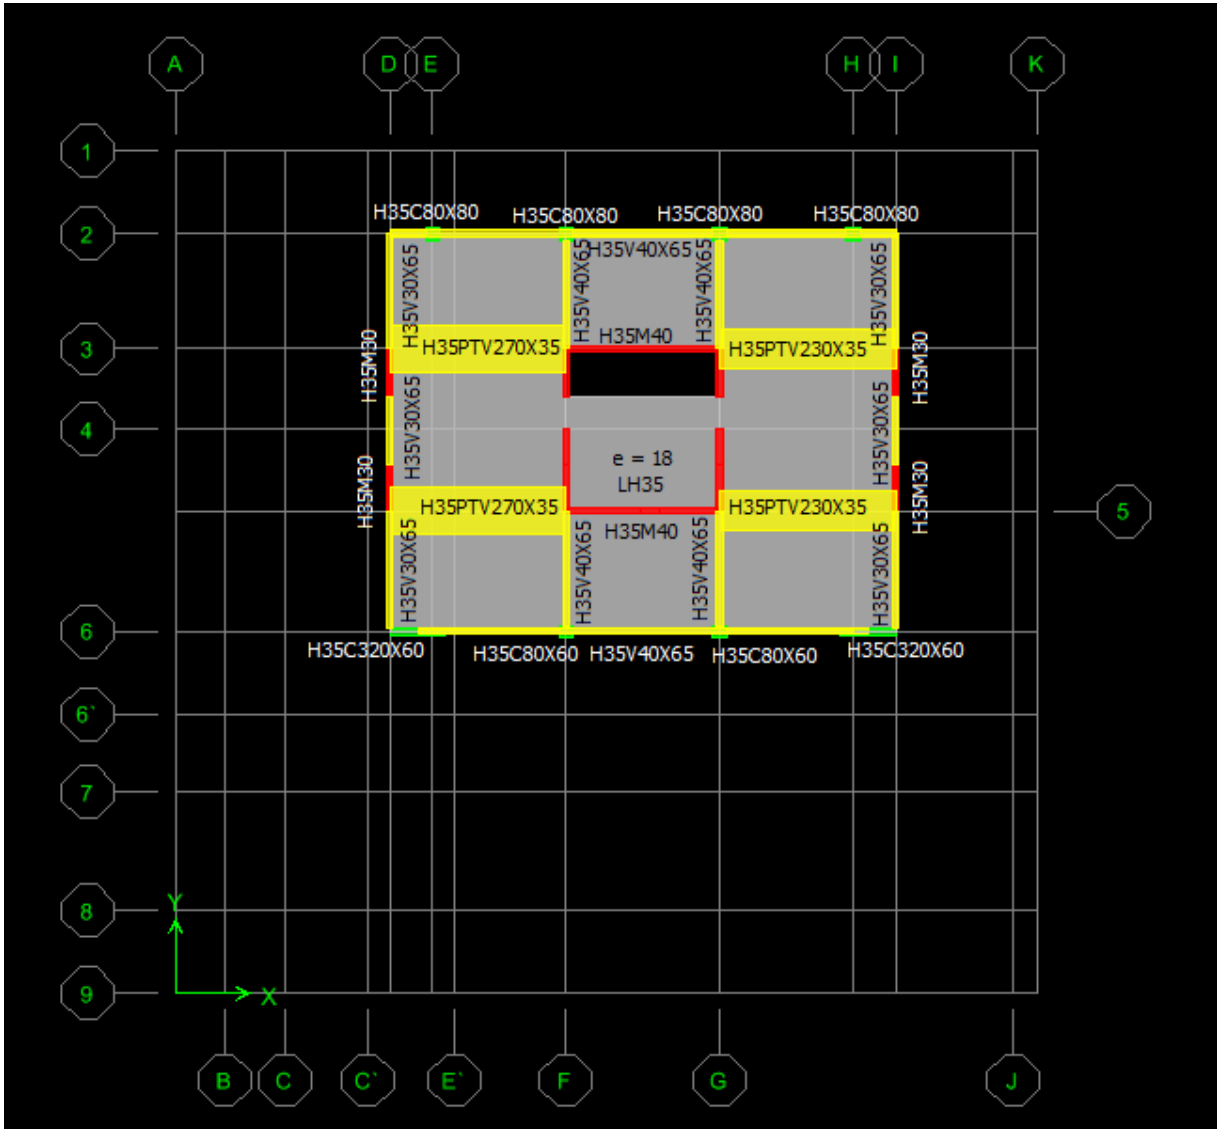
Vista en planta estructuración cielo piso 3 al 16
